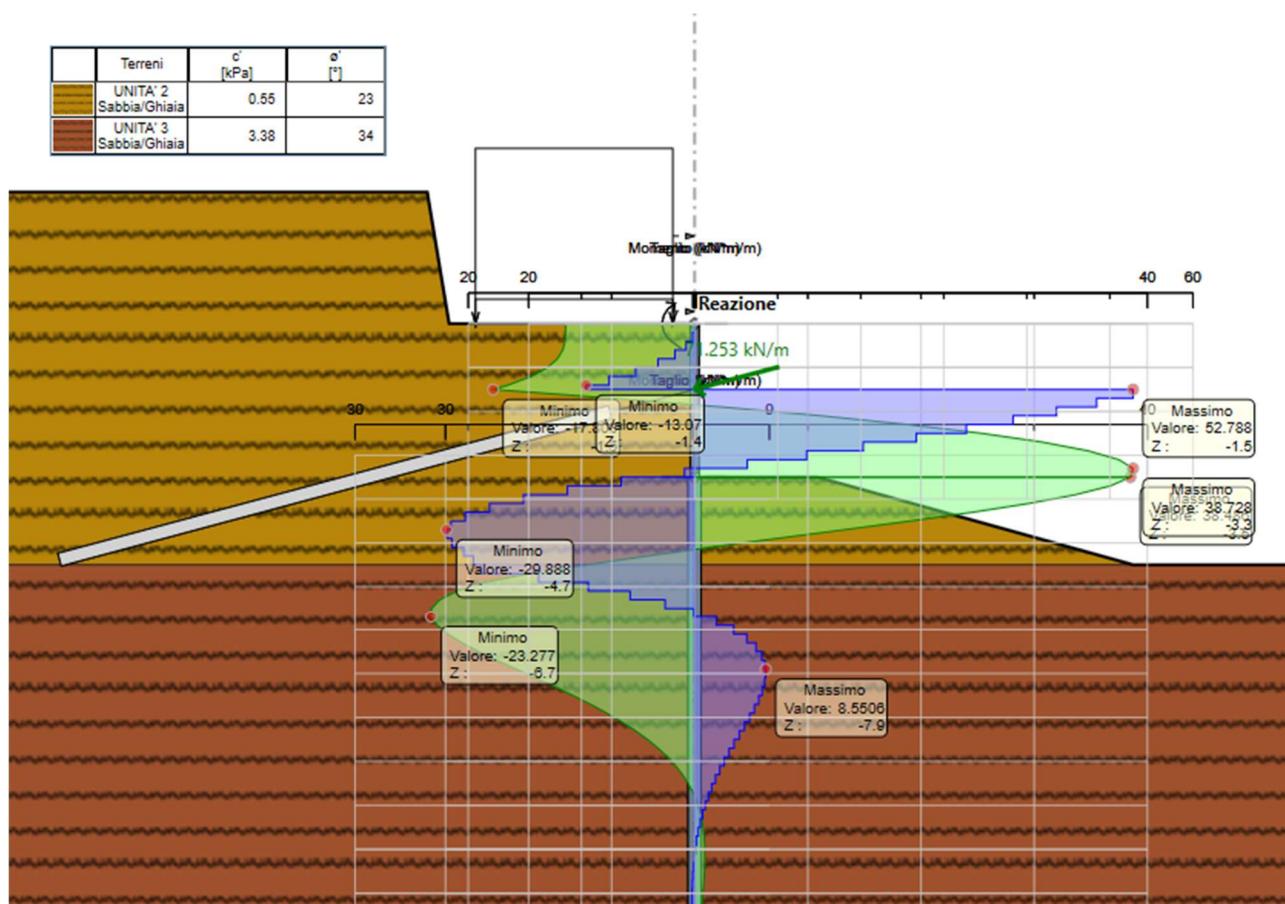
Sollecitazioni sul muro in condizione finale (sezione A)
